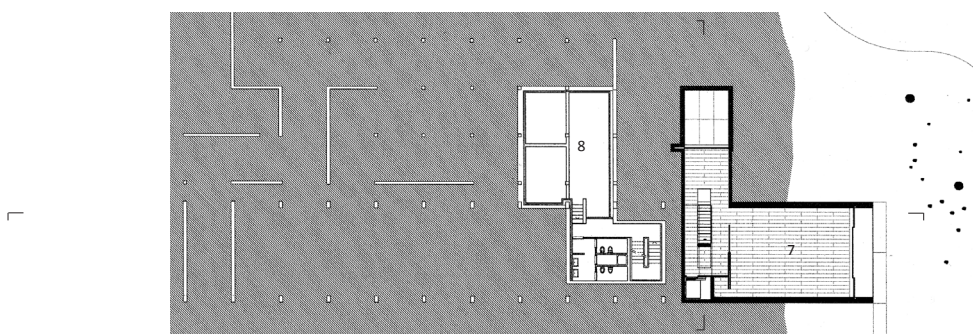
Planta Piso -1 - Primeira proposta de intervenção.
